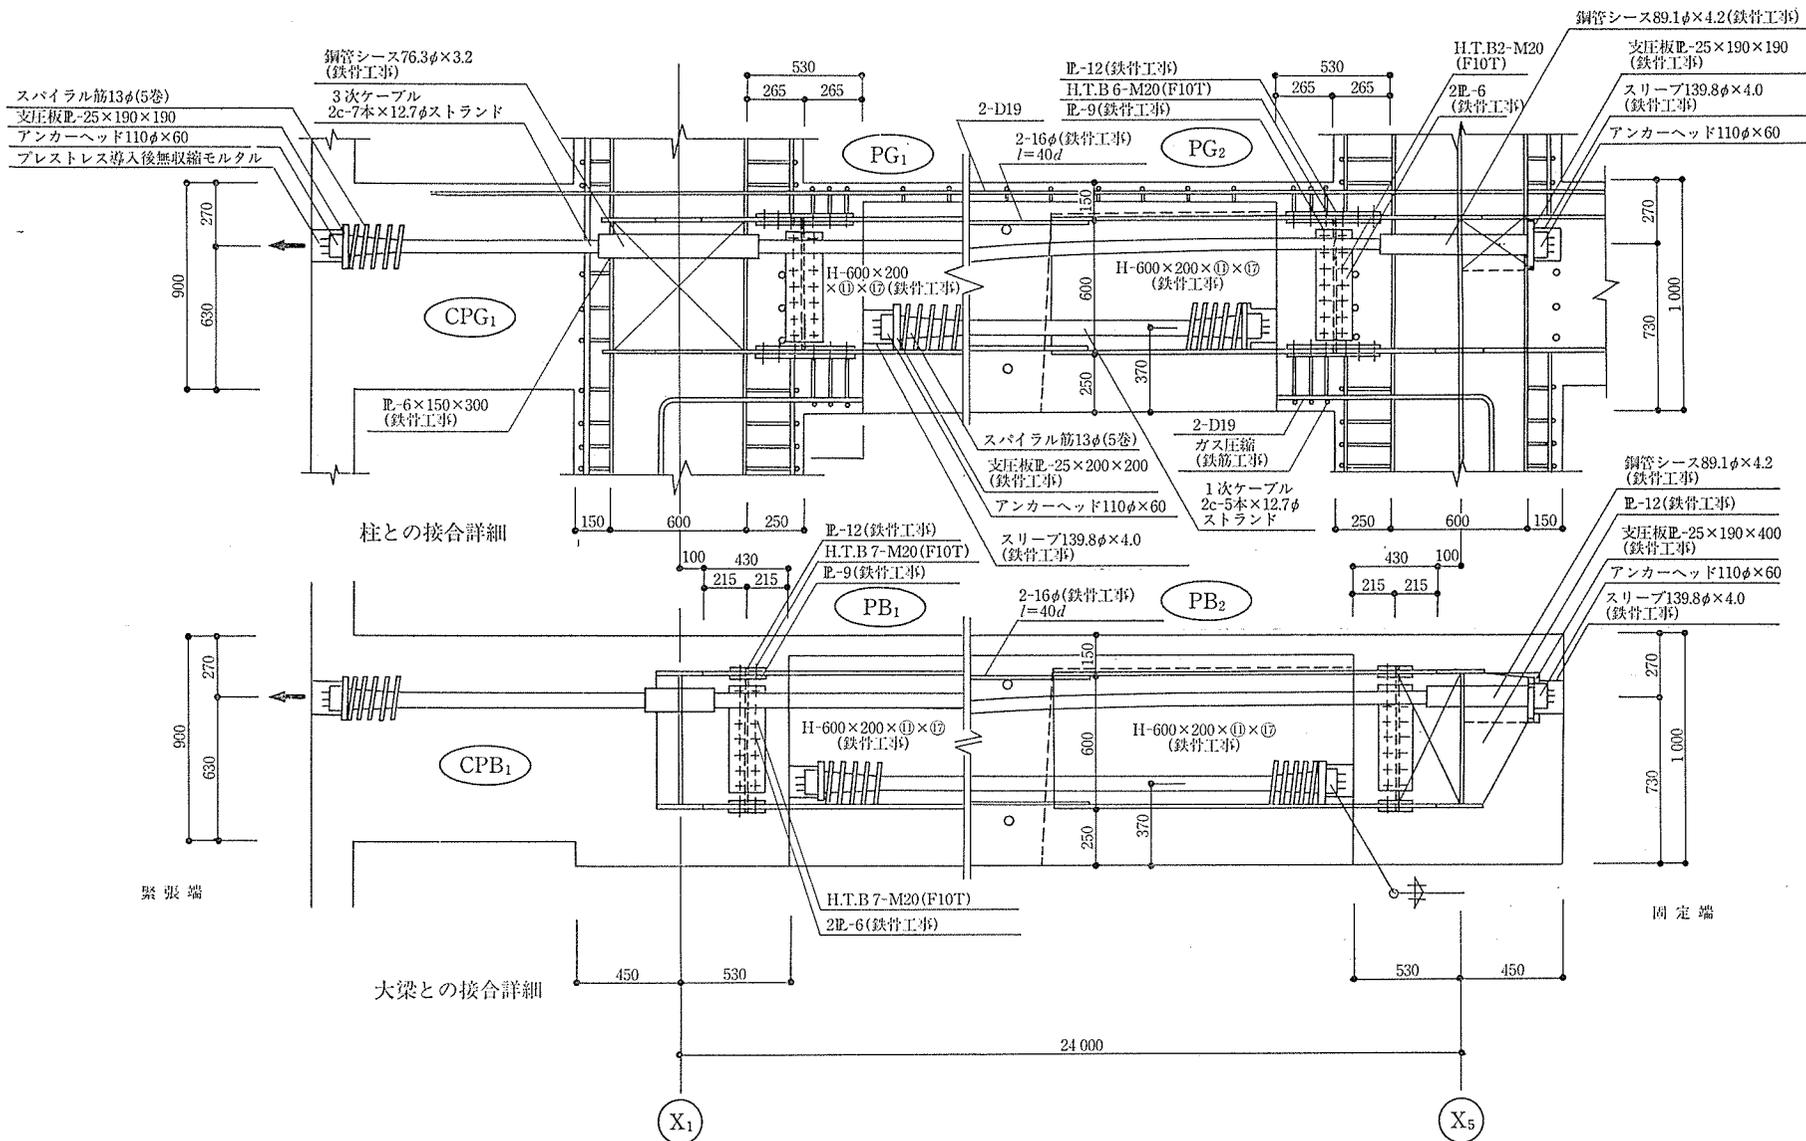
接合部詳細図 (3次ケーブル端部詳細図)
